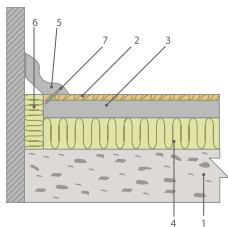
Примыкание полов к стенам и перегородкам:
